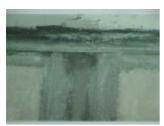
Гидроизоляция стяжки террасы. В средине гидроизоляция деформационного шва между двумя плитами террасы, а сверху гидроизоляция стыка плит со стеной.
